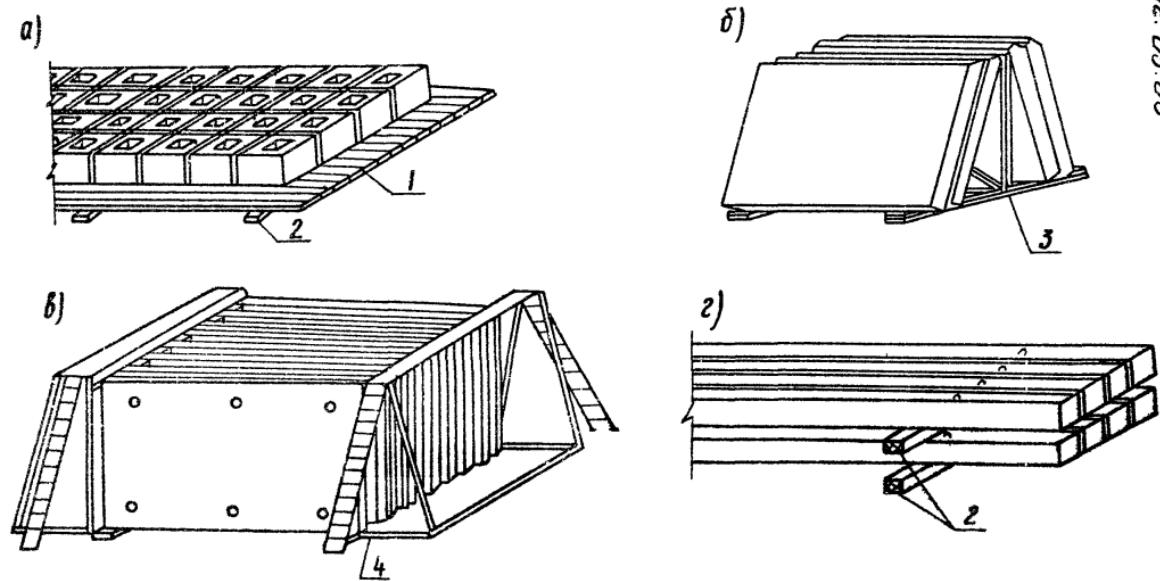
Складирование сборных конструкций: а) отливков; б) покольных панелей; в) панелей перекрытий; г) ростверков и балок. 1-настил из досок 40мм; 2-подкладка 80х80мм; 3-металлическая пирамида на 4 покольные панели; 4-кассета конструкции ГипроагроСельстрой
